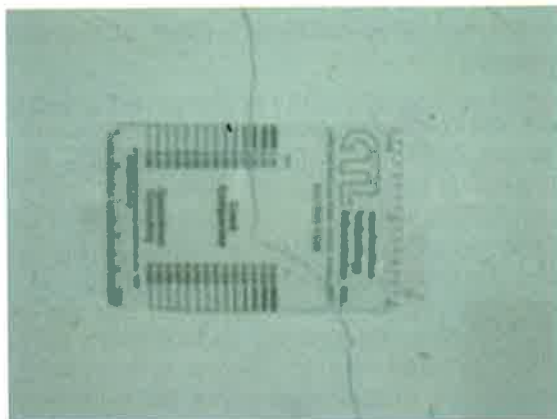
Identificação de fissuras por medição com fissurômetro.
